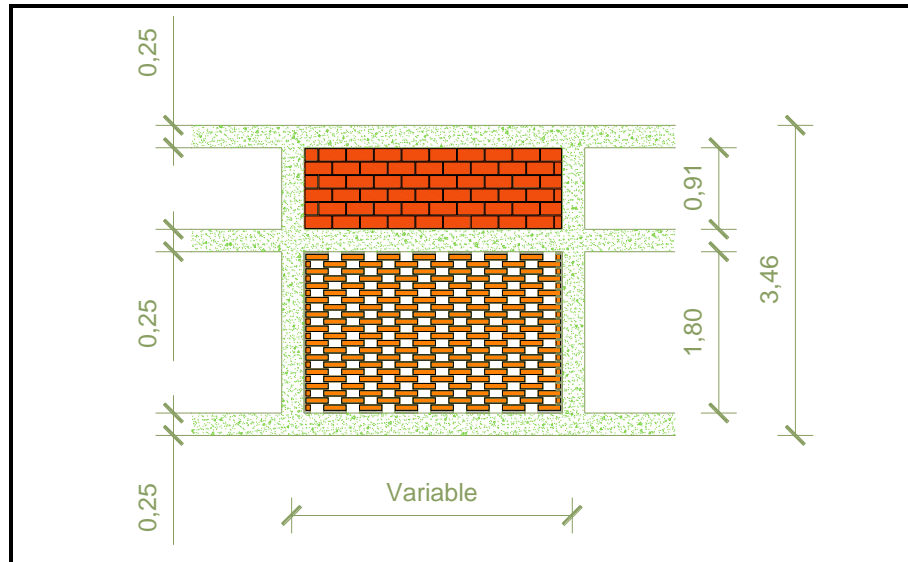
Vista frontal muro no portante perimetral propuesto
